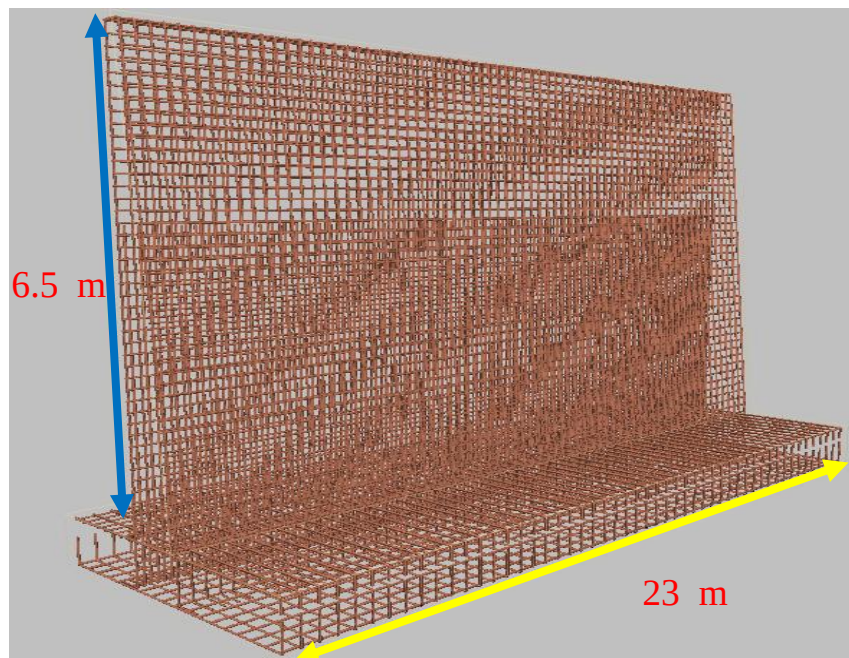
Vue sur l'interface de Structure mur soutènement (armature)
